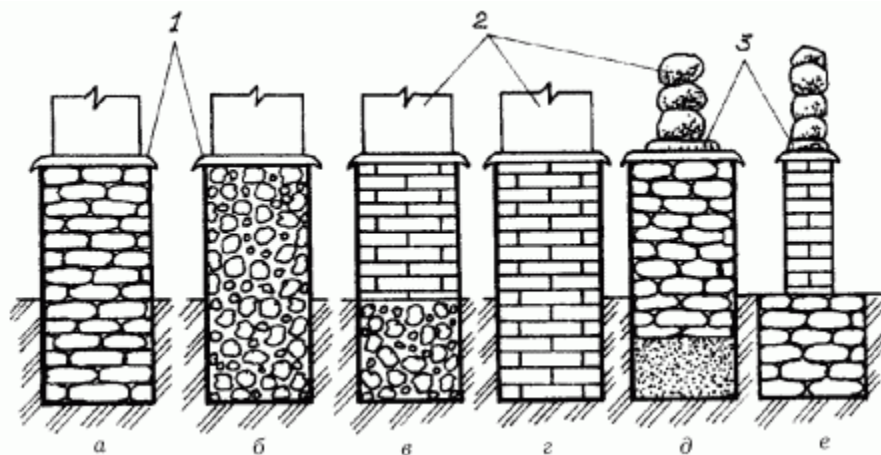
Устройство фундаментов из различных материалов: а – бутовый; б – бутобетонный; в – кирпичный по бутобетону; г – кирпичный; д – бутовый на песчаной подушке; е – кирпичный по буту; 1 – гидроизоляционный слой; 2 – стены; 3 – подкладка.
